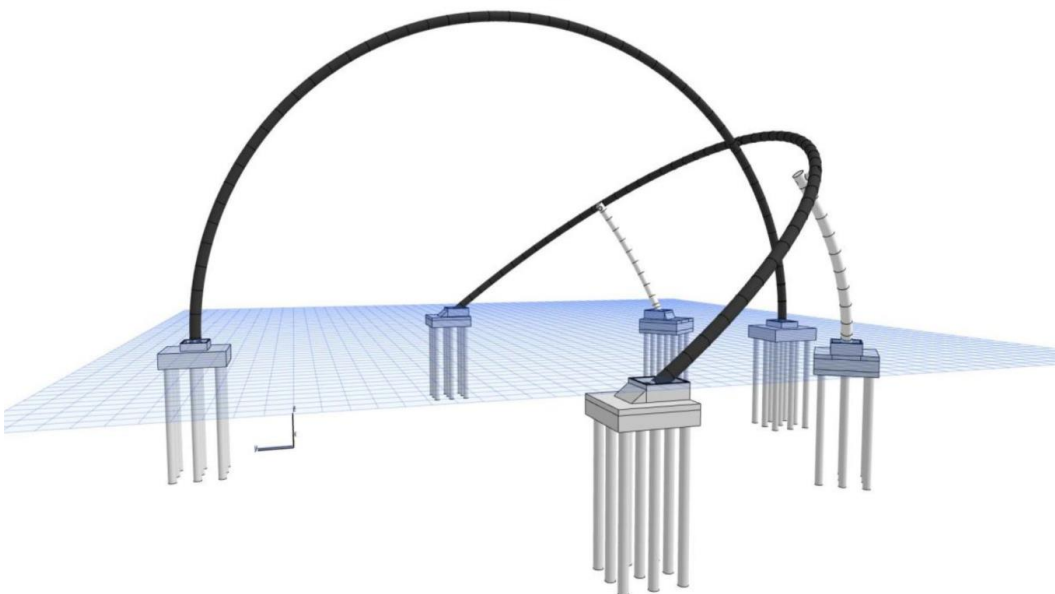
Saniertes Horizontobservatorium mit zusätzlichen Tragelementen (<https://www.rvr.ruhr/>)
